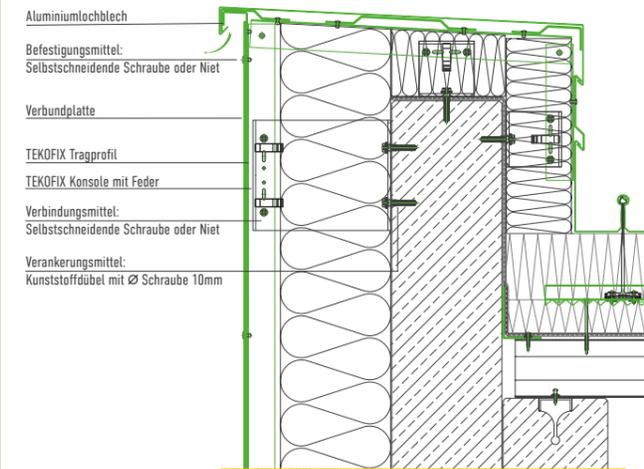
DETAILS – PLANBOND AUF ZWEIFELIGER UNTERKONSTRUKTION
